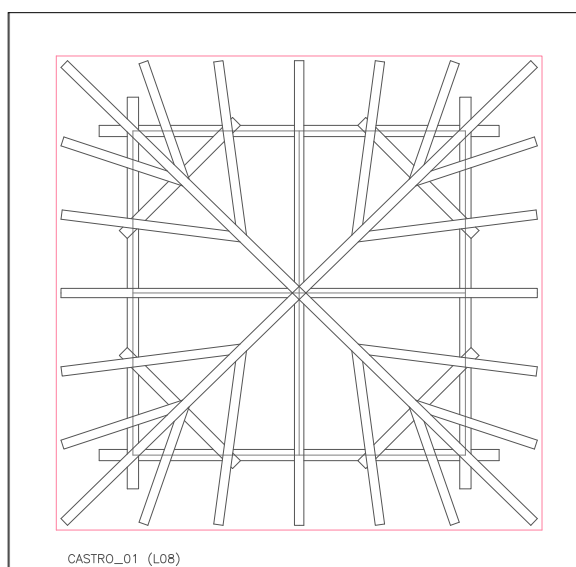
Planta de la estructura de la cubierta. Castro_01 (L08).
